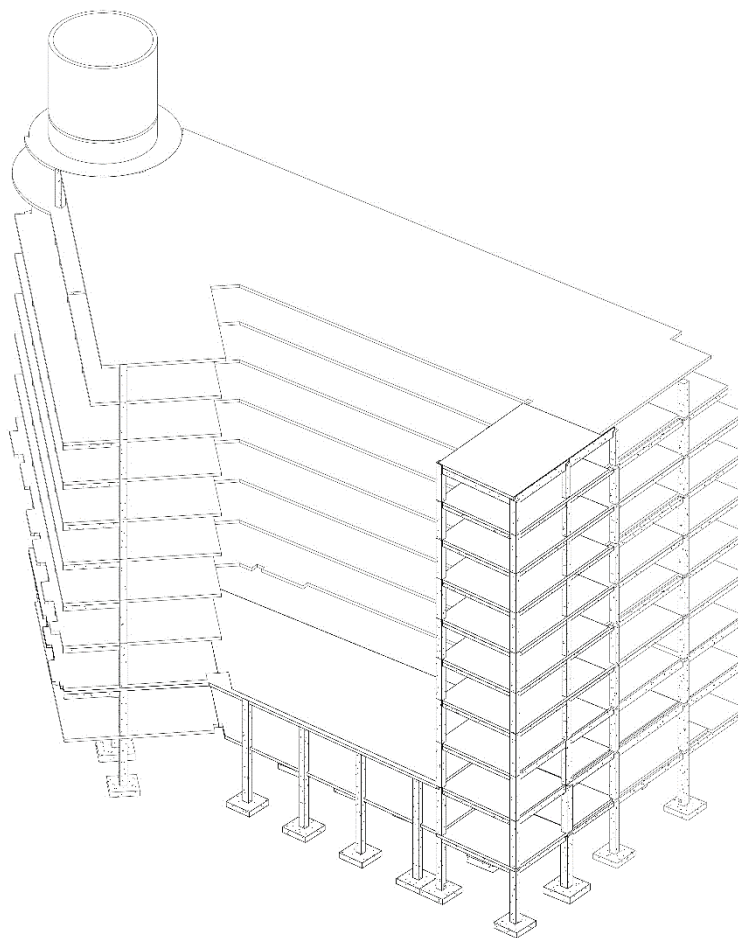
MODELO COM A FASE DA CONSTRUÇÃO EXISTENTE ATIVA
